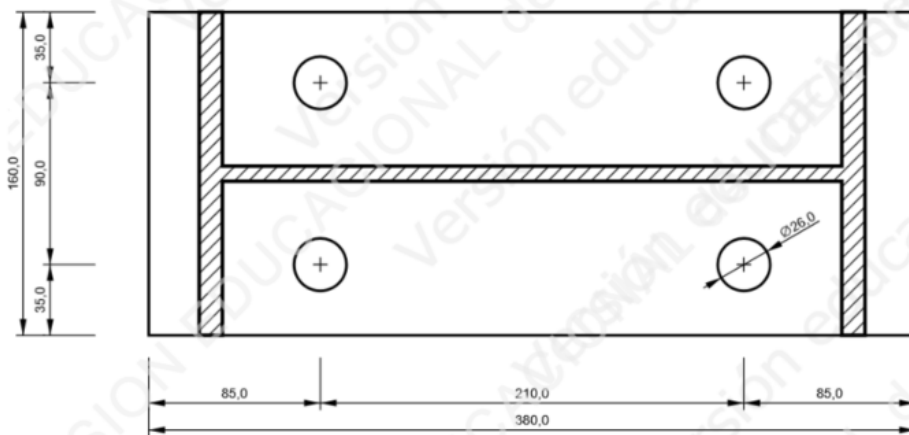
Placa de testa de la unión de IPE330 sin cartela
